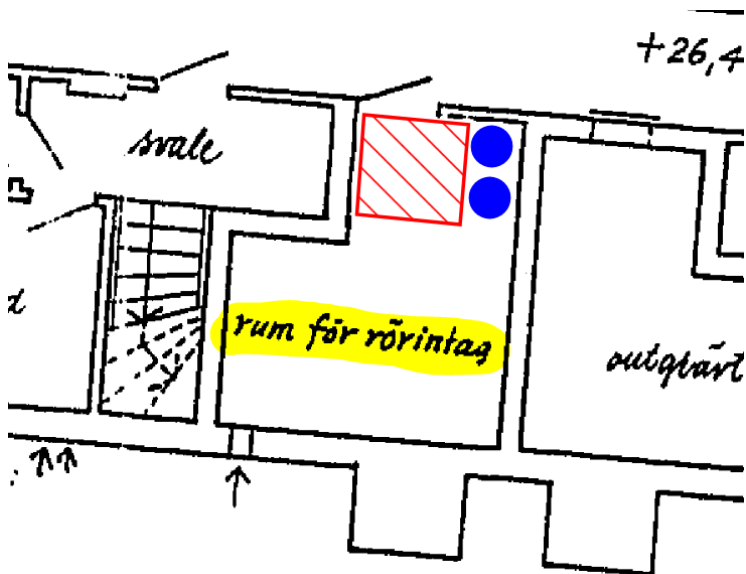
Principiellt läge gemensamma installationer (blåa markeringar) och access-yta (rödrandig markering).
